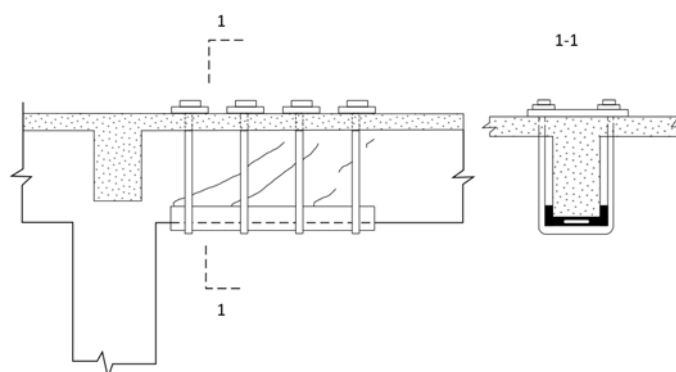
Saniranje armaturnim šipkama dva AB elementa
